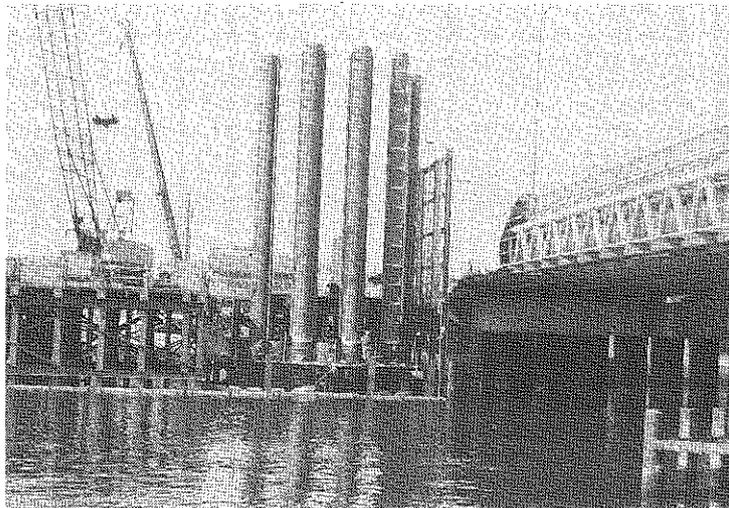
2 曙運河B終点方橋脚鋼管井筒施工
